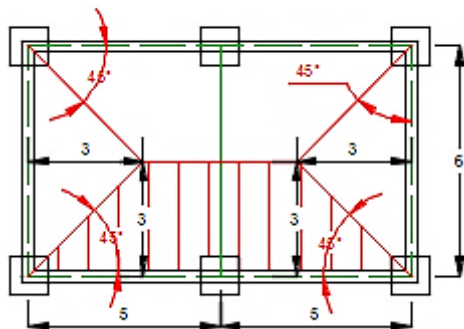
a) Esquema do tipo de apoio e consequentes linhas de ruptura na laje ( a tracejado – carregamento na viga )
